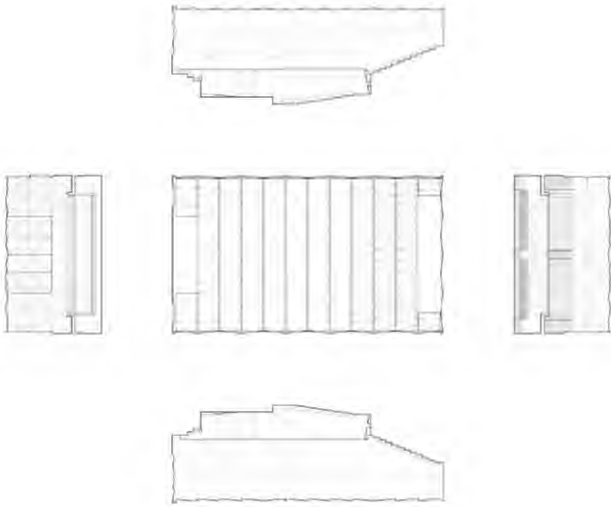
Despiece estructural de la fachada. Fuente: Barozzi Veiga (2014).
